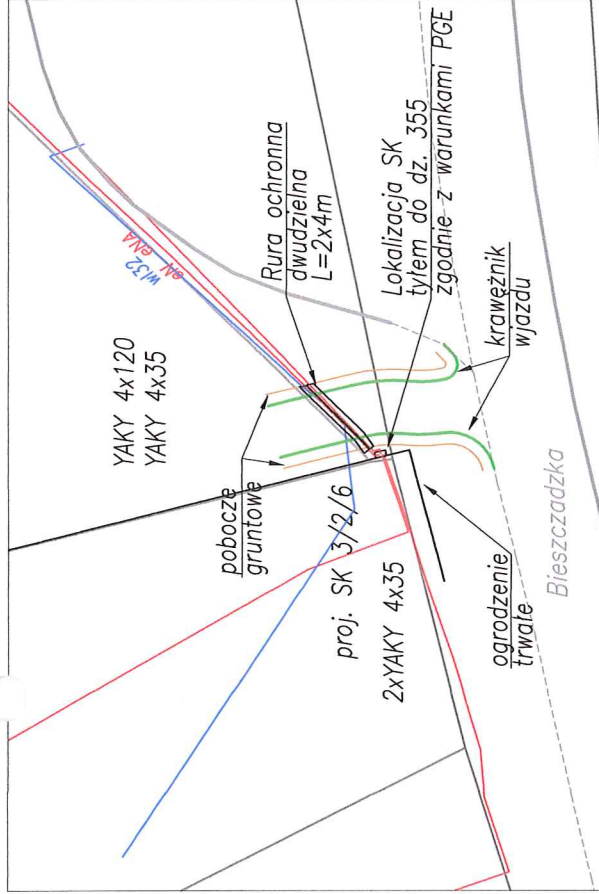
; E-3.2; E-5.1; E-6.1; E-6.2; E-7.1; E-7.2 – Profile skrzyżowań.
